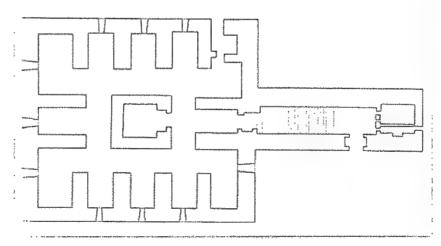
مسقط أفقي تحيلي لبوابة البرادعيين الموحدية، عمل الباحث.
